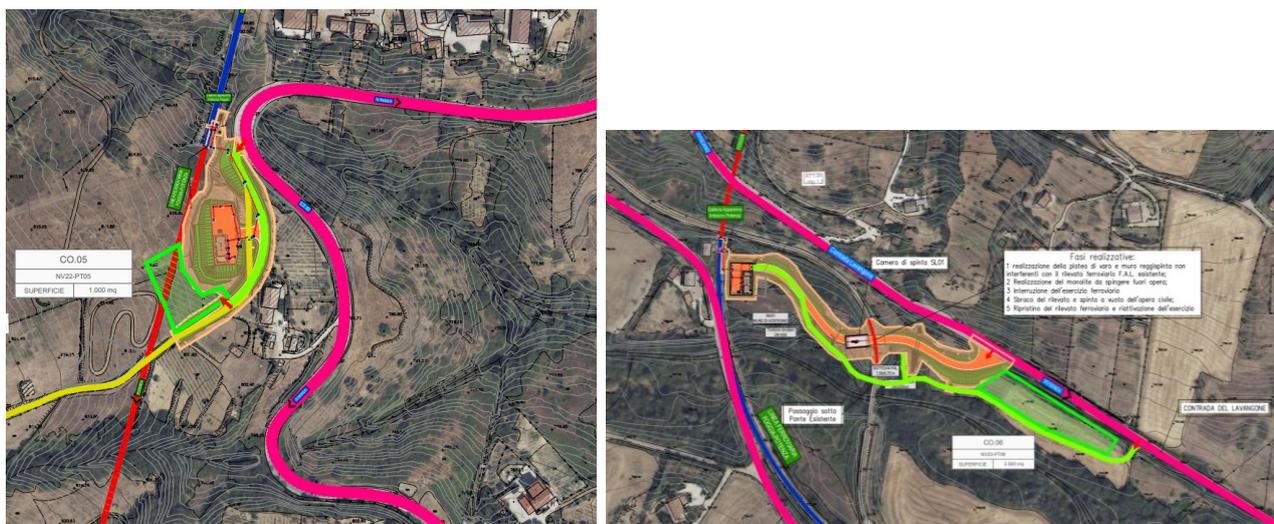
Planimetria con indicazione delle aree di cantiere e della viabilità connessa. Galleria Appennino lato Foggia (sinistra) e lato Potenza (destra) (Fonte: Allegati alla Lista di controllo)
